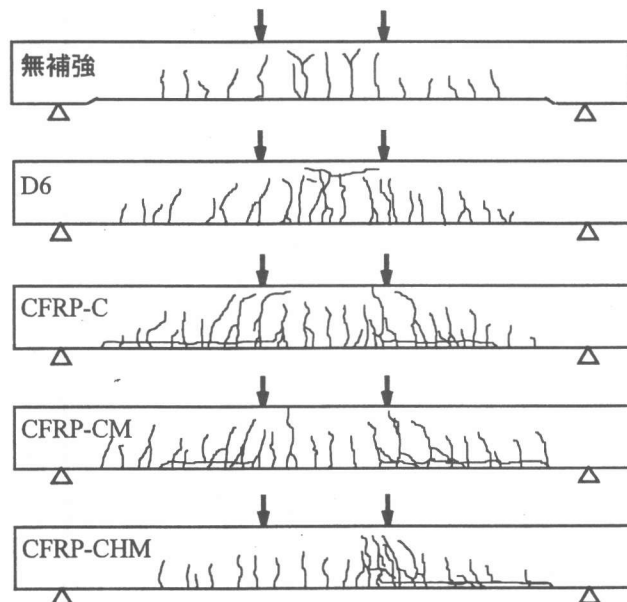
ひび割れの分散状況 (こて塗り工法)
